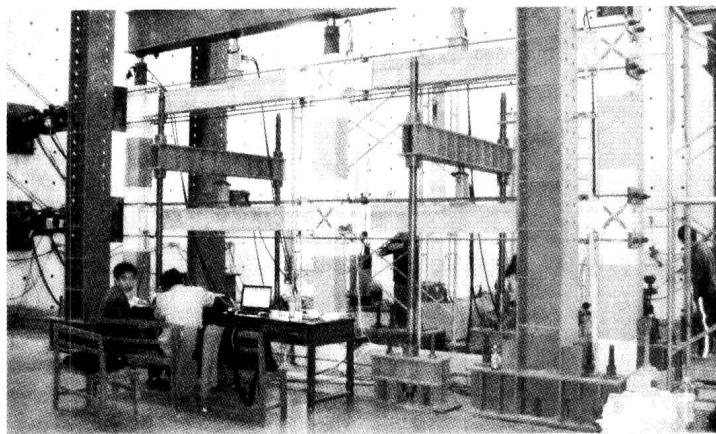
预压装配式钢筋混凝土框架低周反复加载试验
